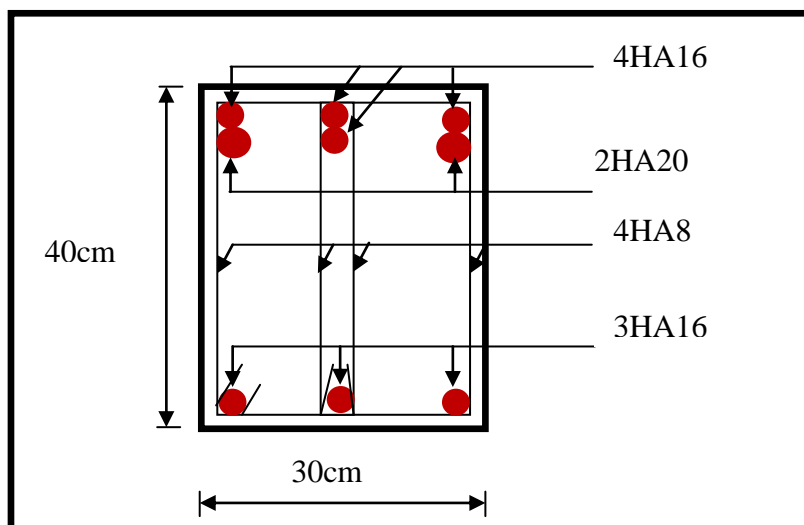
Ferrailage sur appuis d'une poutre principale.
